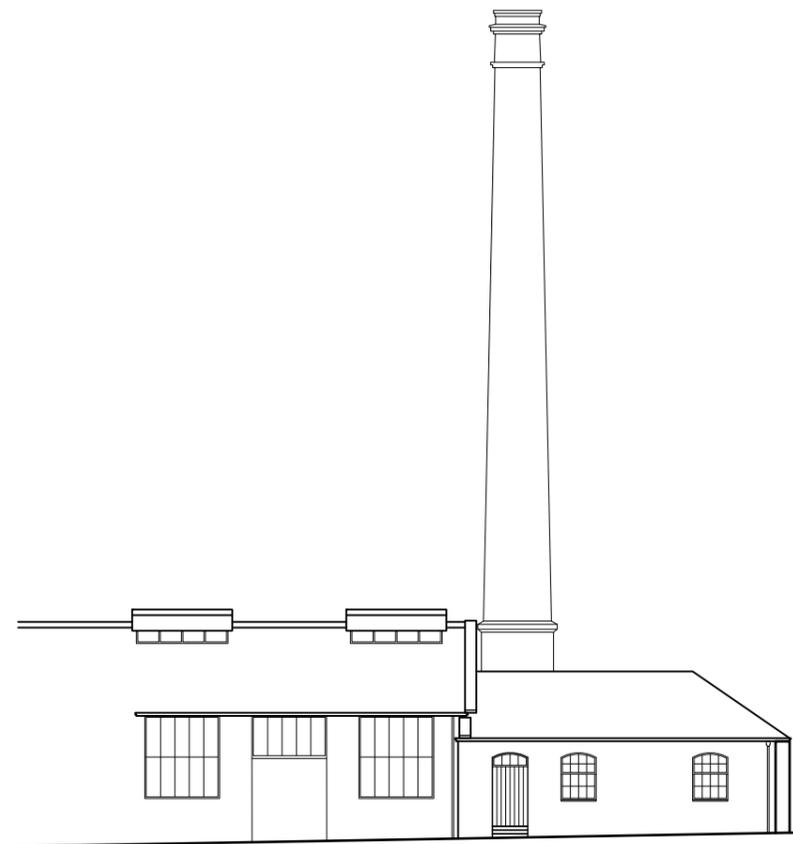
Ansicht 1 - Schmiede, Maschinenraum
